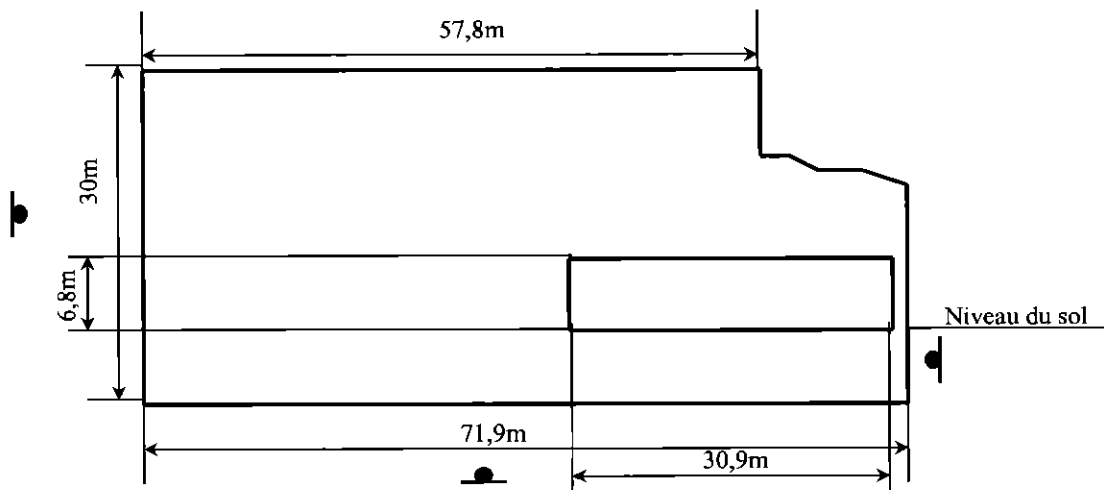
Géométrie de la section 3D : coupe transversale de la salle des sarcophages
